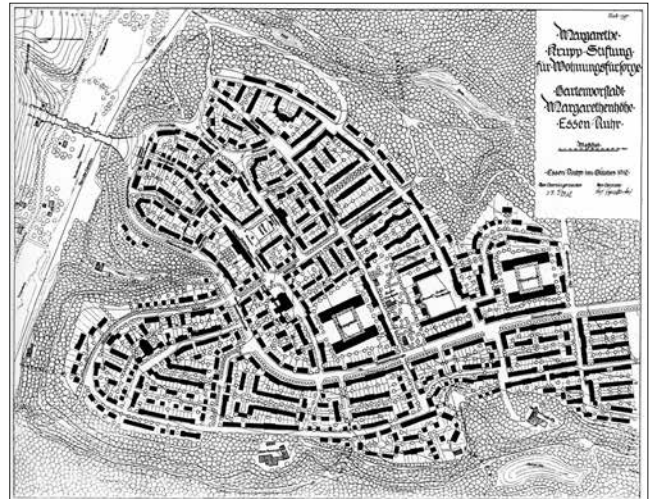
Essen, Gartenstadt Margarethenhöhe, Georg Metzendorf, begonnen 1909, Bebauungsplan, Planungsstand 1912
